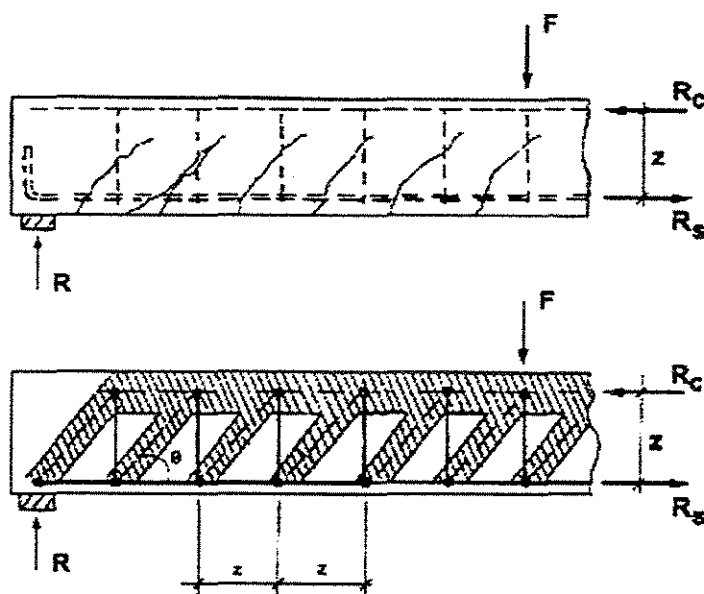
Viga com armadura transversal constituída por estribos verticais e esquema de treliça
